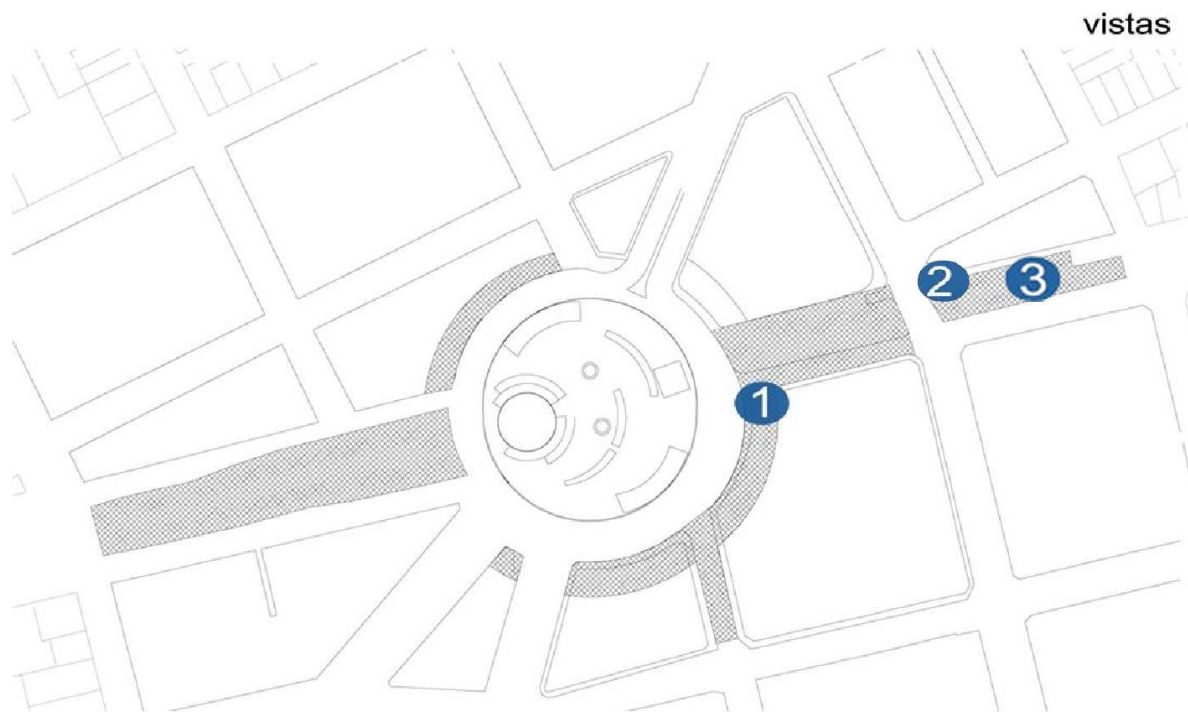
Ubicación en planta vistas 1, 2 y 3. Propuestas esquemáticas de reconfiguración del espacio.
